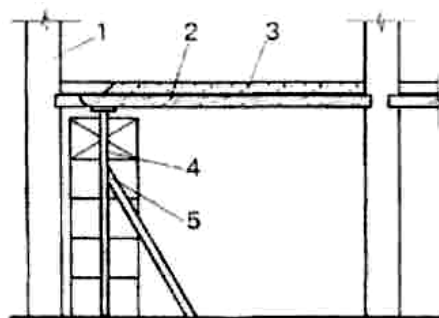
Схема робіт по підсиленню дерев'яних балок кінцевими протезами: 1 - існуючі стіни; 2 -балка, що підсилюється; 3 - конструкція перекриття; 4 - тимчасова опора; 5 - підмост
